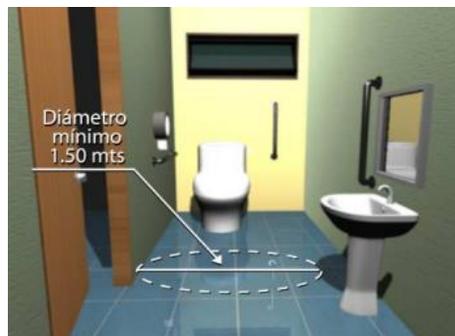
Angulo de giro dentro del cubículo sanitario.
